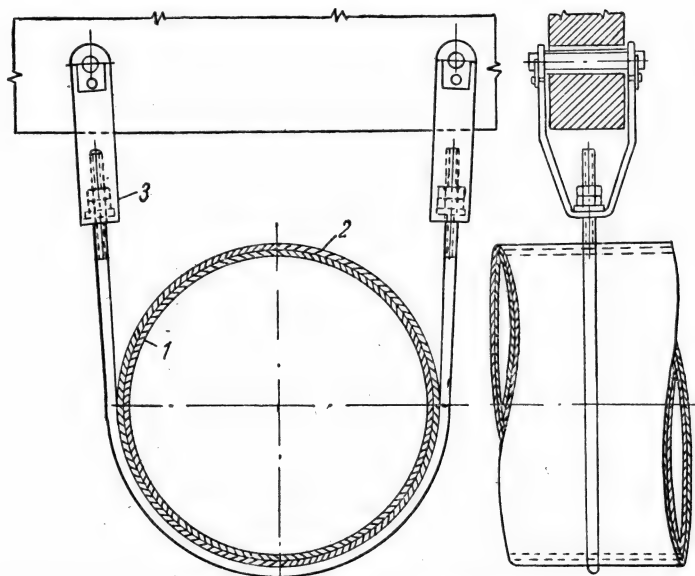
Подвеска газопровода осушенного газа под железобетонным мостом:
